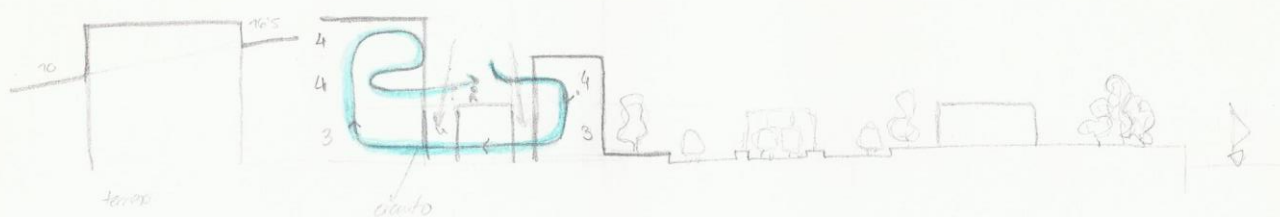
Ensaio corte centro de exposições. Fonte: Autora
